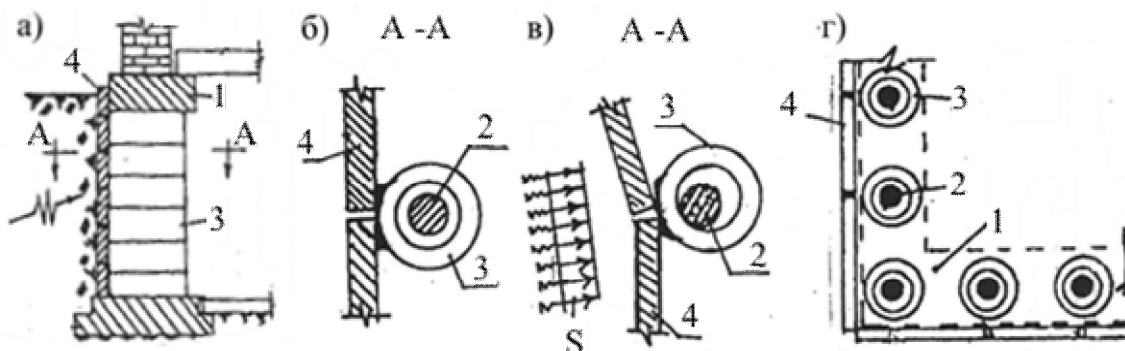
Комплексные конструкции сейсмоизолируемых стен. а – общий вид фундамента с сейсмоизолирующими элементами (фрагмент); б – разрез по А-А, до деформации, в – разрез по А-А, после деформации; г – план расположения ростверка (пунктирная линия) и колонн с шайбой (фрагмент); 1 – ростверк; 2 – фундаментная колонна; 3 – опорная шайба; 4 – ограждающая стена
